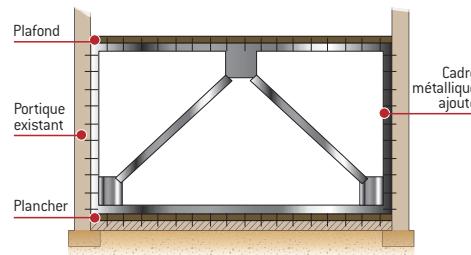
Exemple de renforcement du contreventement par ajout de croix de type K ou Saint-André en charpente métallique ou en poutre de béton armé à un portique existant (coupe transversale)
